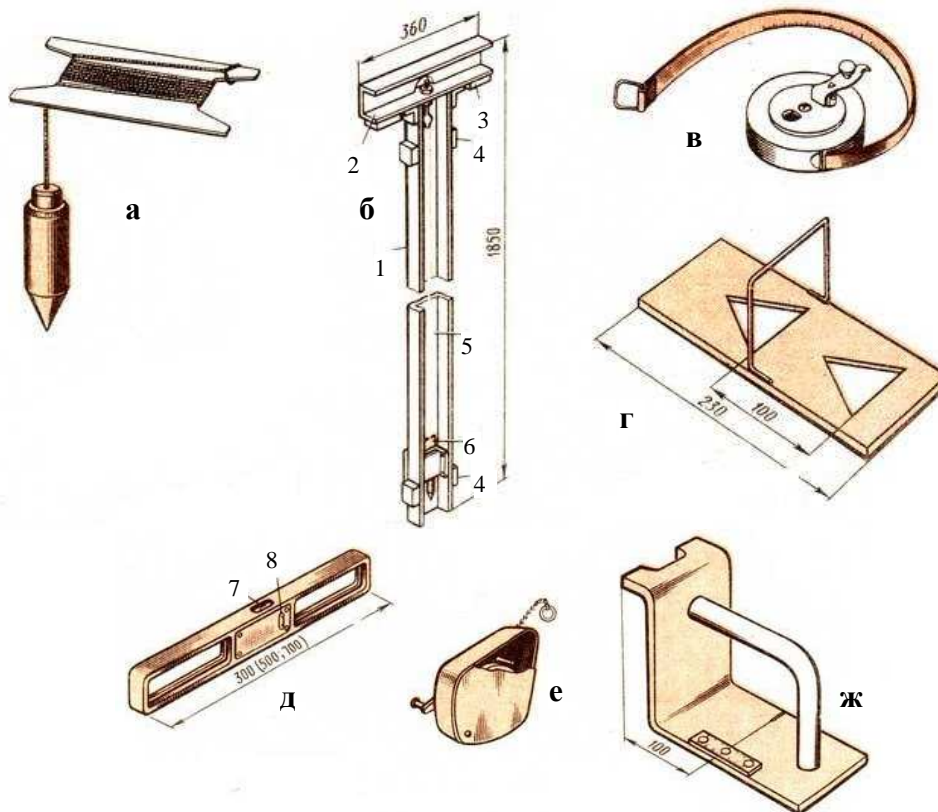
Контрольно-вимірювальні інструменти: а – рейка з виском; б – висок; в – рулетка; г – шаблон для позначок; д – будівельний рівень; е – розмітний шнур; ж – шаблон для установлення панелей; 1 – корпус; 2 – поперечина; 3 – підкладки; 4 – упор; 5 – висок; 6 – шкала; 7 – ампула горизонтального рівня; 8 – ампула прямовисного рівня
